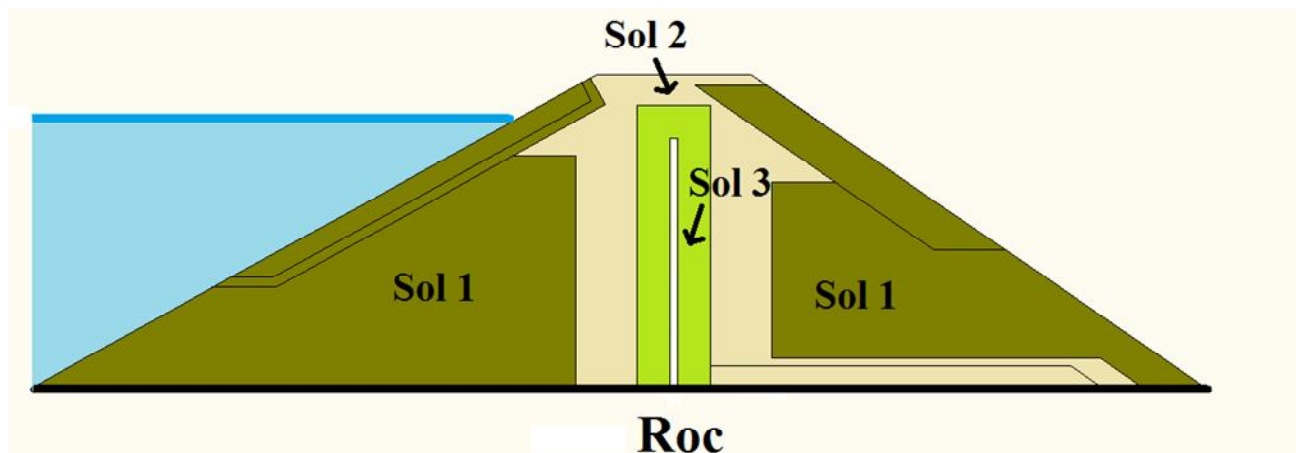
coupe transversale du barrage de Nemiscau-1 mettant en évidence le zonage du barrage
